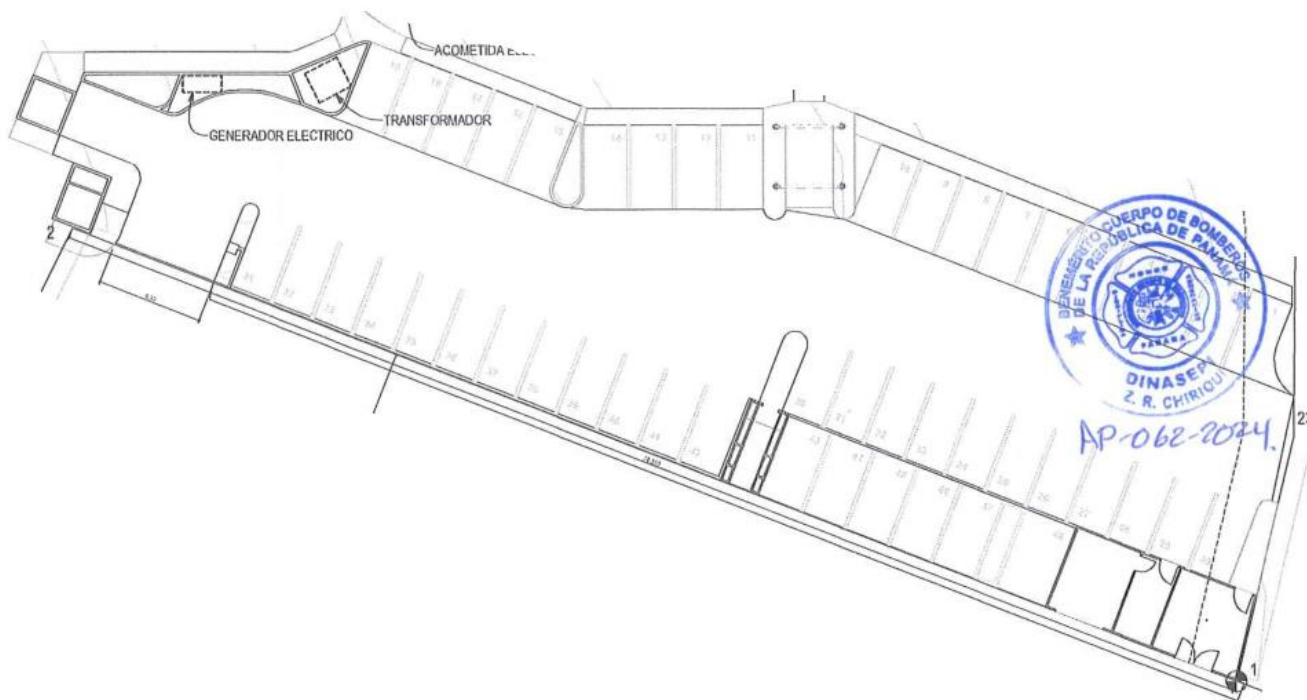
ESTACIONAMIENTOS. PLANTA BAJA “BOQUETE RIVER VIEW”
